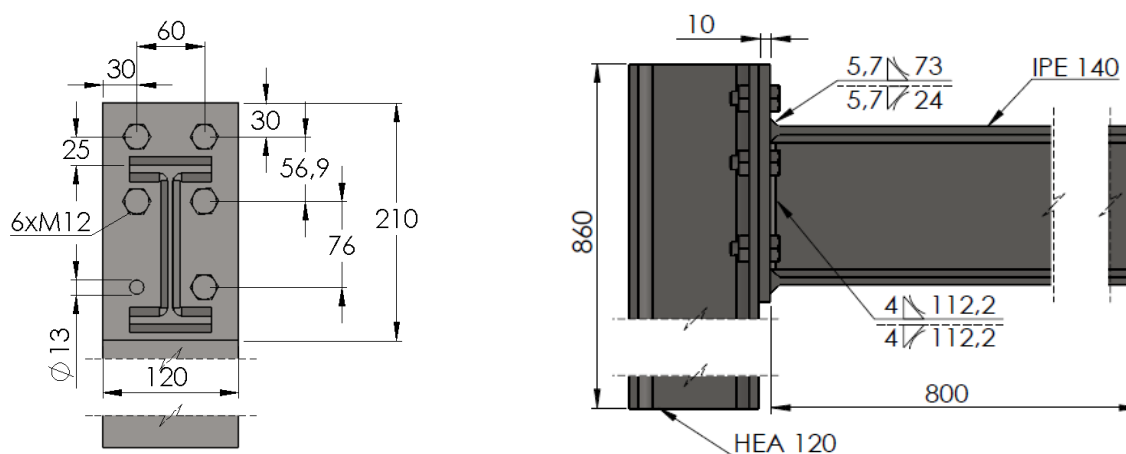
Dimensões finais de todas as componentes da ligação viga-pilar.
